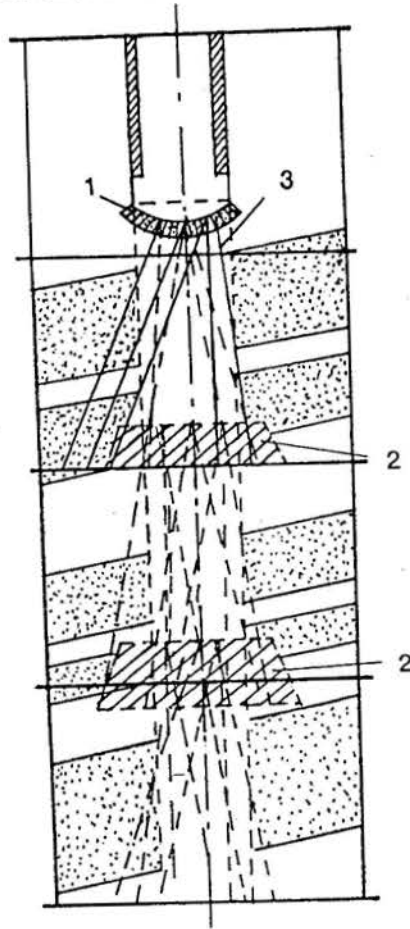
Cementación desde el frente del pozo por zonas, dejando una almohada de hormigón y pilares.
